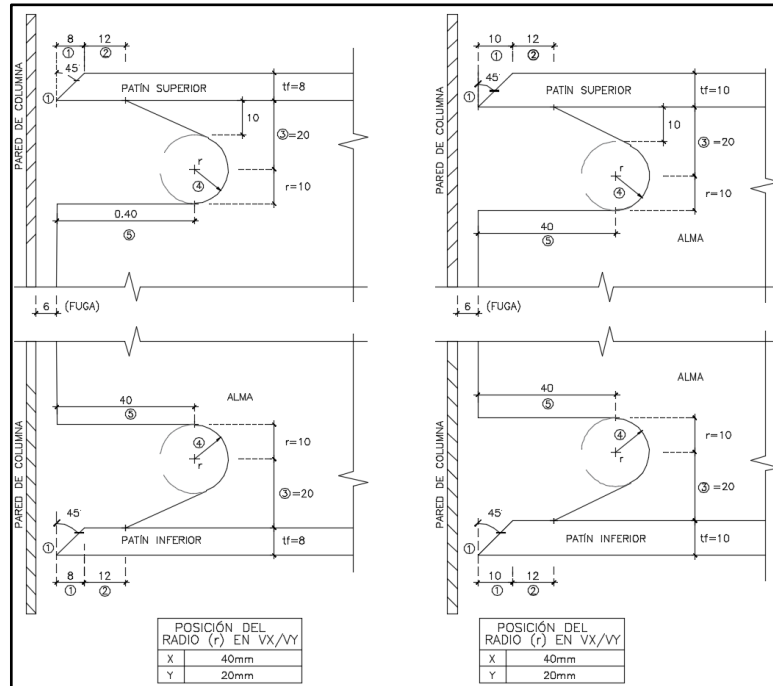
Geometría de agujero de acceso para soldadura $t_f=8-10\text{mm}$
